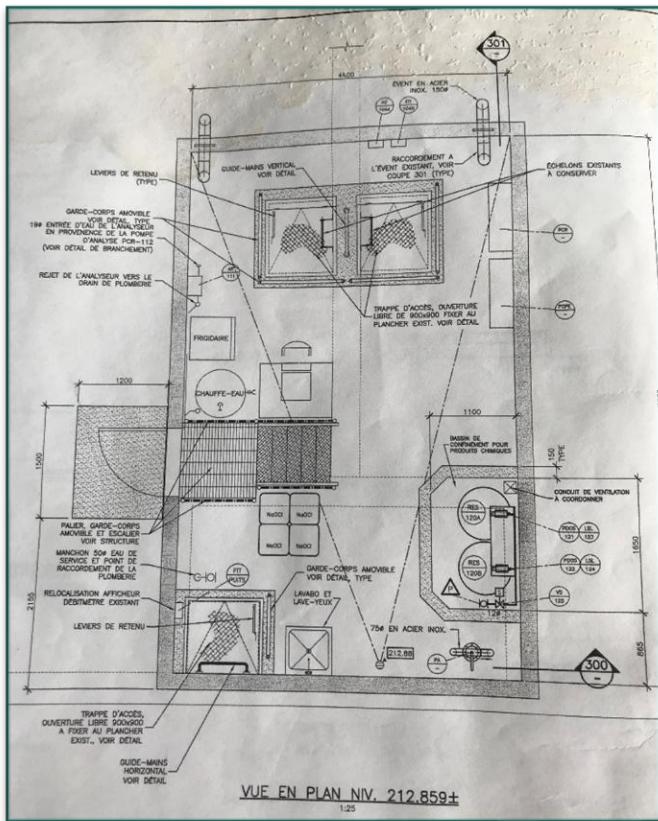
Vue en plan de l'usine de traitement d'eau potable.
